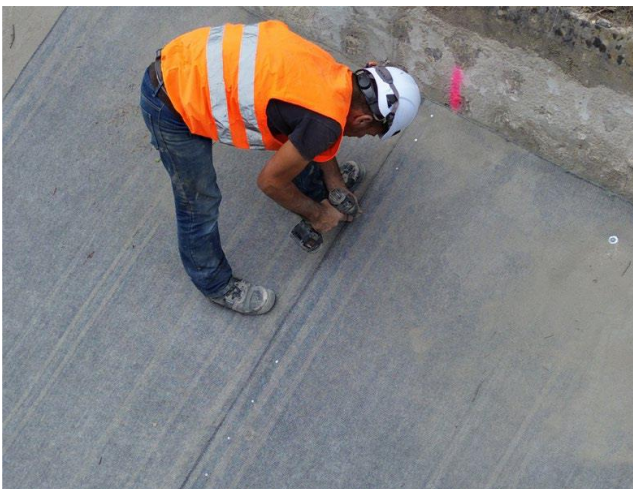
Exemplu de canal făcut din material ”Concrete Canvas”
